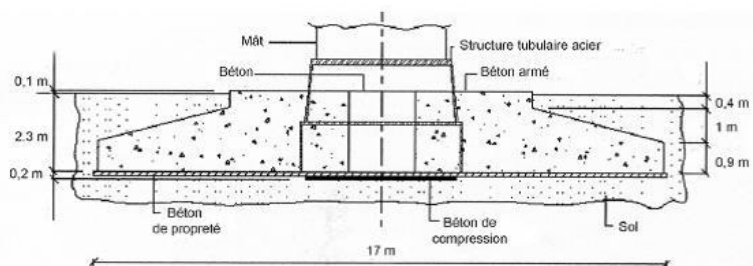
Vue générale d'une fondation pour éolienne type retenue
